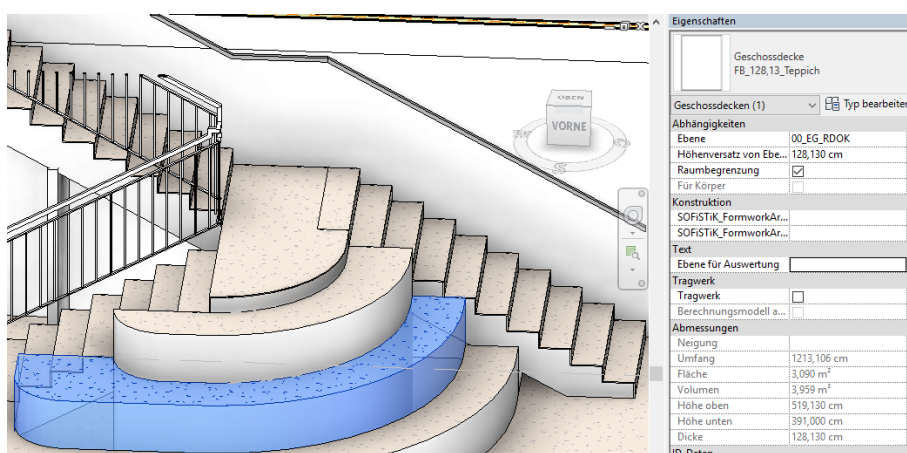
Work-Around Treppe/Geschossdecke
